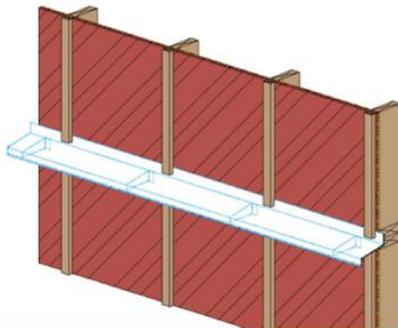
Jonction plancher - mur, continuité du pare-vapeur
